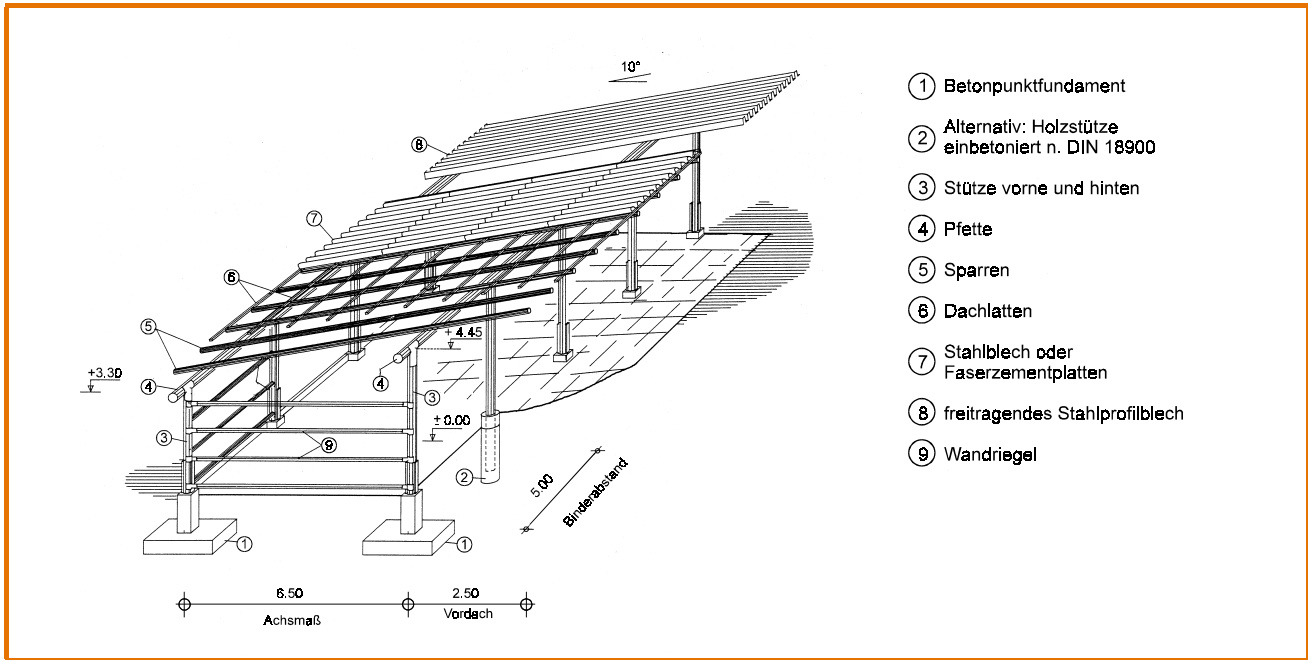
Rundholz-Pultdachhalle mit Rundholzverbindern [3-47]
